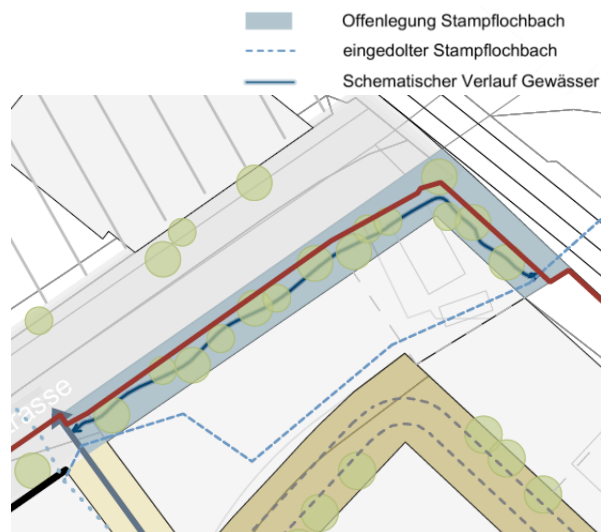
Ausschnitt Bachöffnung, Masterplan 2022
